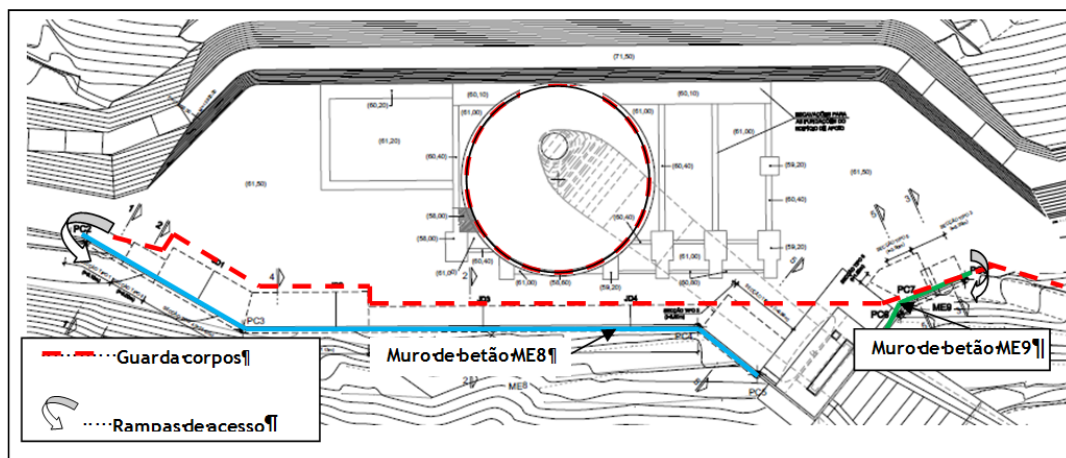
Representação esquemática da planta de localização dos muros de contenção (Fonte: PTRE)
